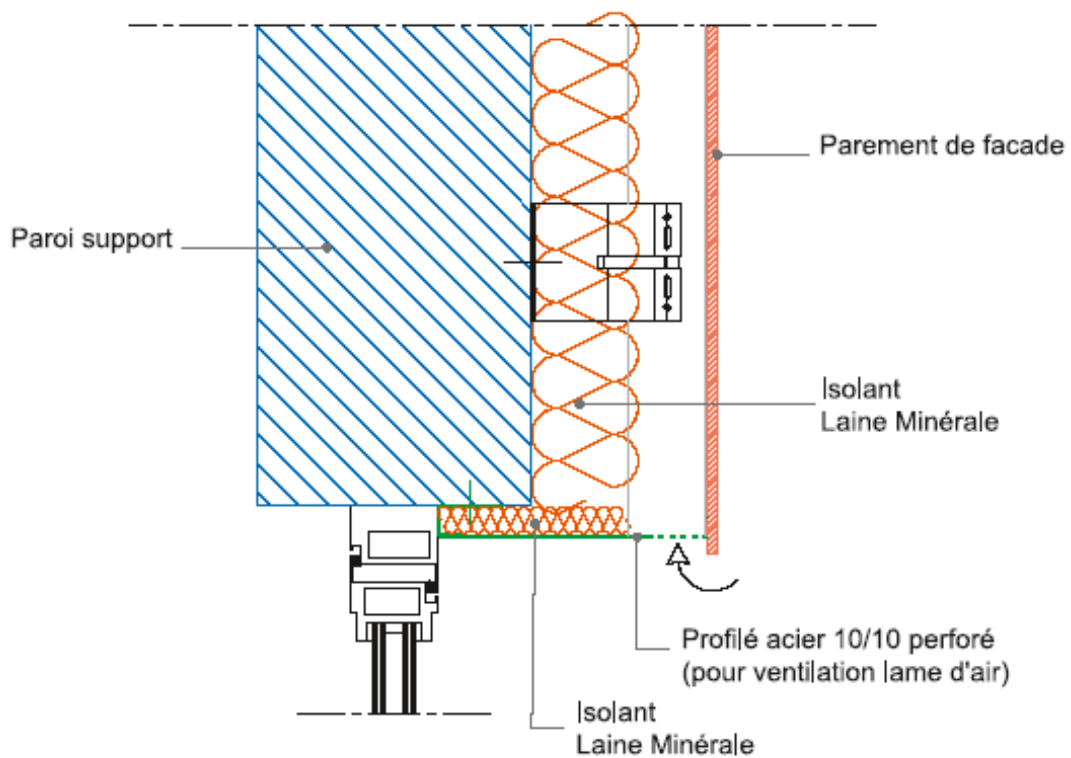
Coupe verticale encadrement de la baie niveau linteau
